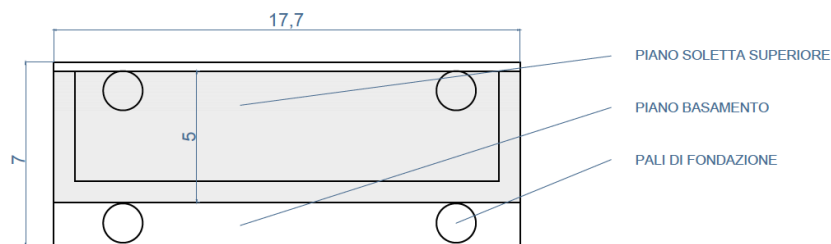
vista in pianta della spalla tradizionale, quotata in m
